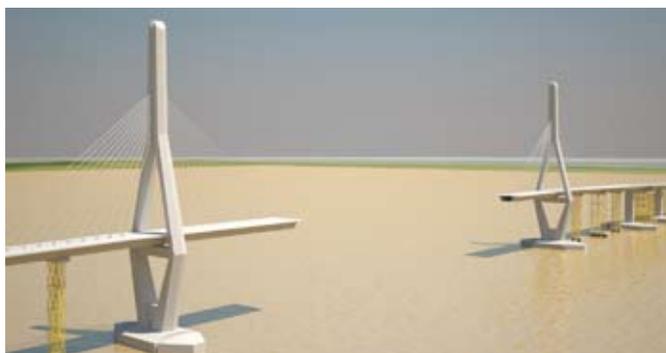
Procedimiento constructivo previsto para el Puente Principal, alternativa de hormigón.
